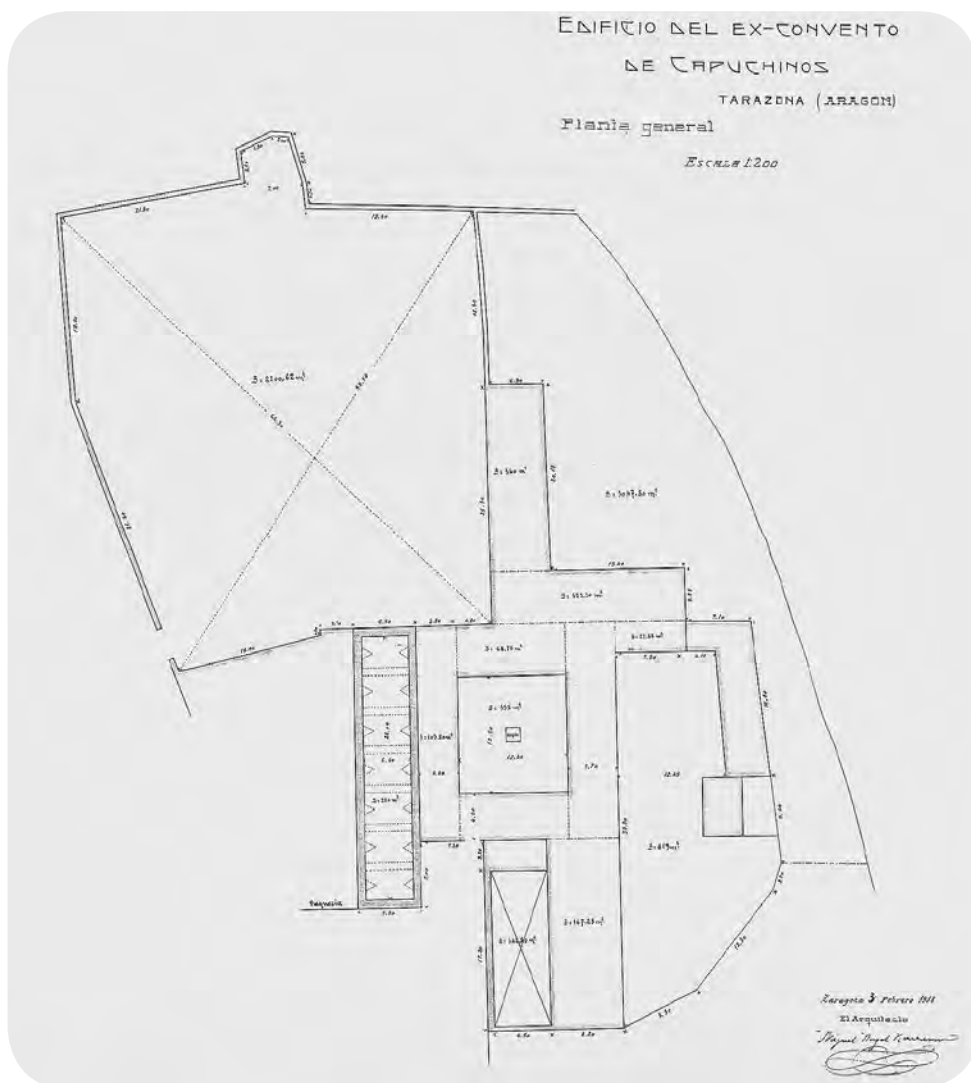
Planta del convento de capuchinos, arquitecto Miguel Ángel Navarro, 1918. Plano A.M.T.
